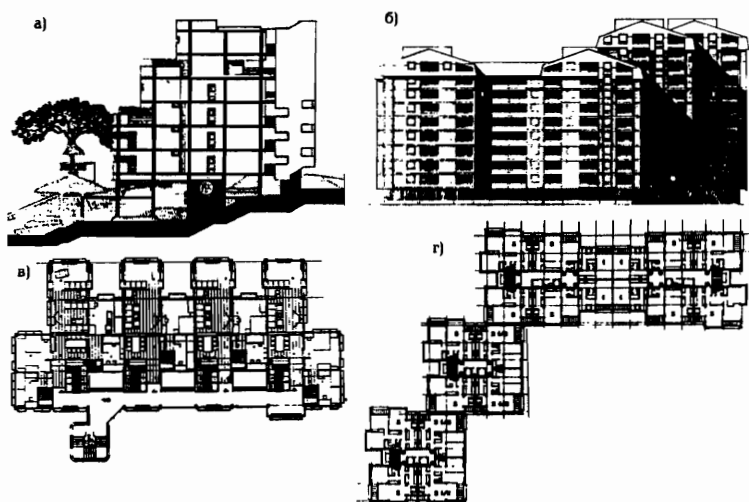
Архитектурно-планировочные решения многоэтажных жилых зданий: а – ступенчатого типа с учетом рельефа местности; б – многосекционные разноэтажные блокировочного типа; в, г – планы типовых этажей
